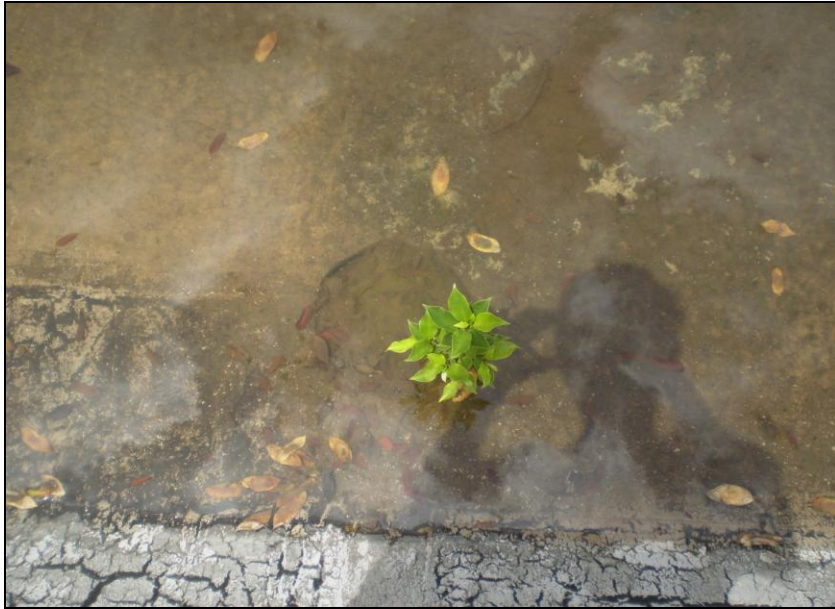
Formación de pozos en la azotea por drenaje obstruido.
